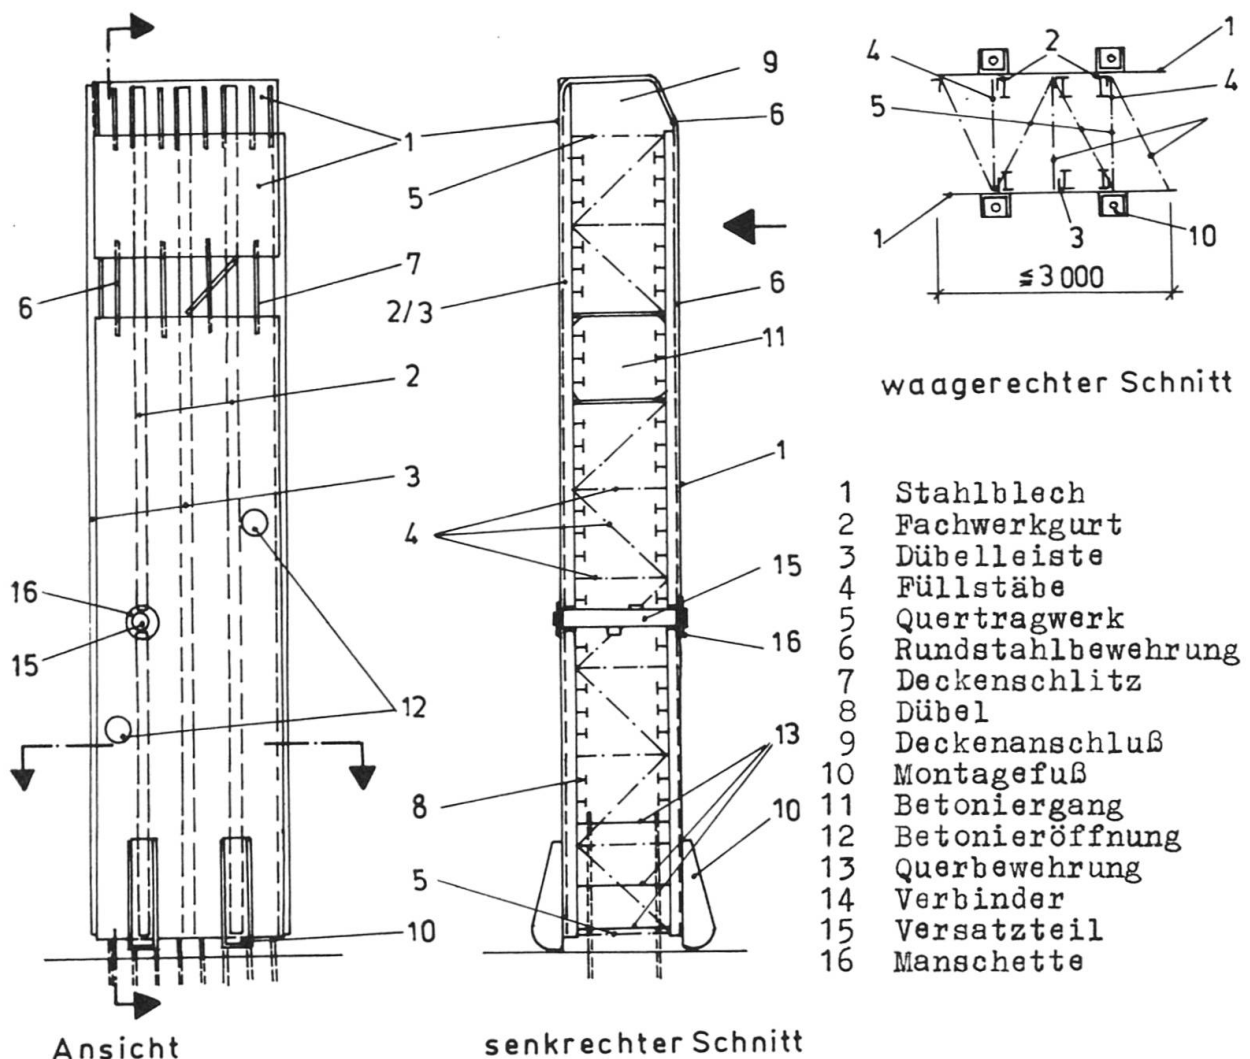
Konstruktionsprinzip der Stahlzellenverbundbauweise; Wandzelle mit zweiseitiger Blechbewehrung
